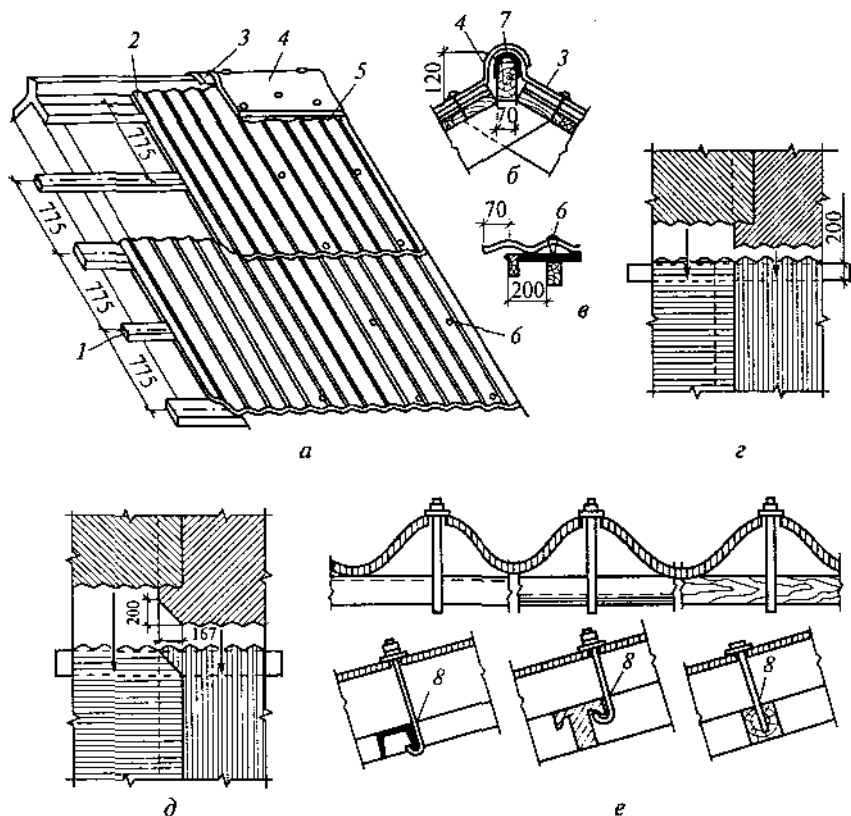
Покрытие крыши волнистыми асбоцементными листами: *а* — часть ската; *б* — поперечный разрез конька; *в* — то же, фронтона; *г*, *д* — укладка листов со смещением и обрезкой углов; *е* — варианты крепления листов к металлическим, железобетонным и деревянным прогонам; *1* — обрешетка; *2* — лист; *3*, *4* — коньковые асбоцементные элементы; *5* — обмазка мастикой; *6* — кровельные гвозди; *7* — гидроизоляционная лента; *8* — крюк
